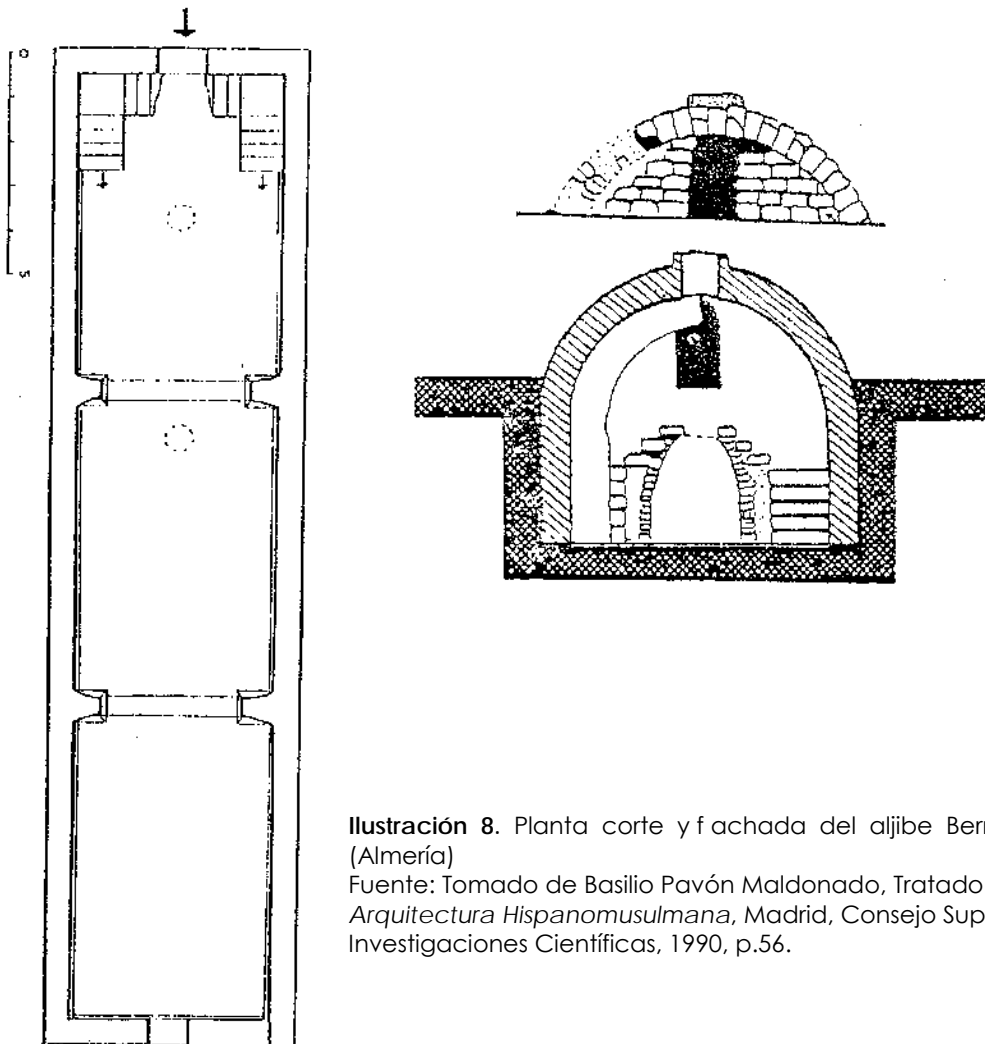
Planta corte y fachada del aljibe Bermejo, Nijar (Almería)
